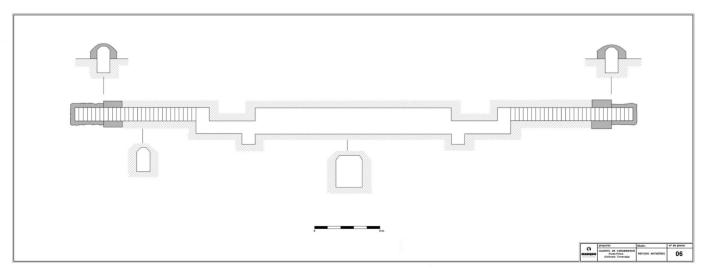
Planimetría del refugio antiaéreo de Punta Prima
